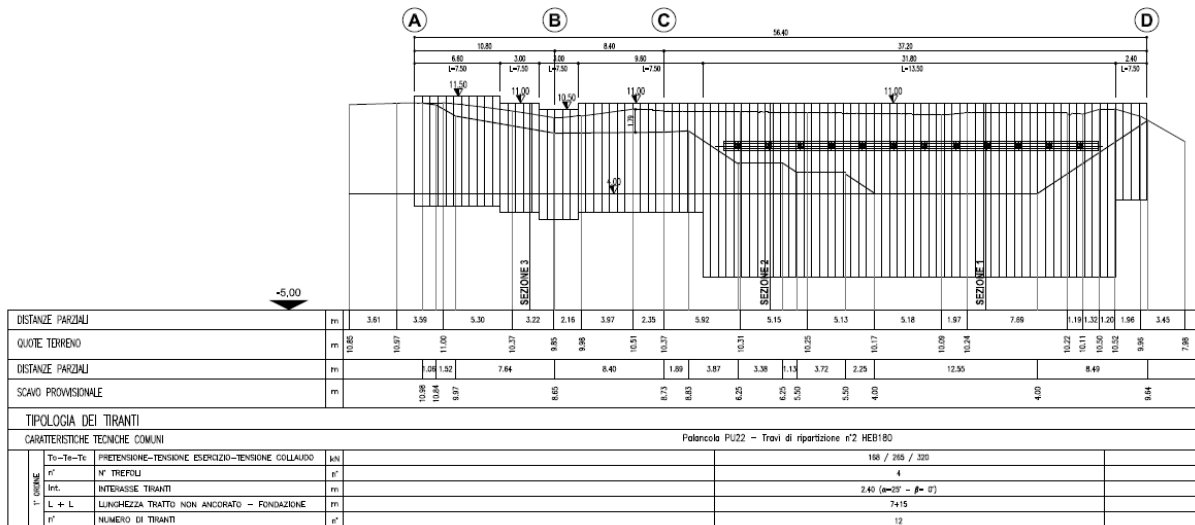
Muro TA222: sviluppo in pianta palancola e prospetto
